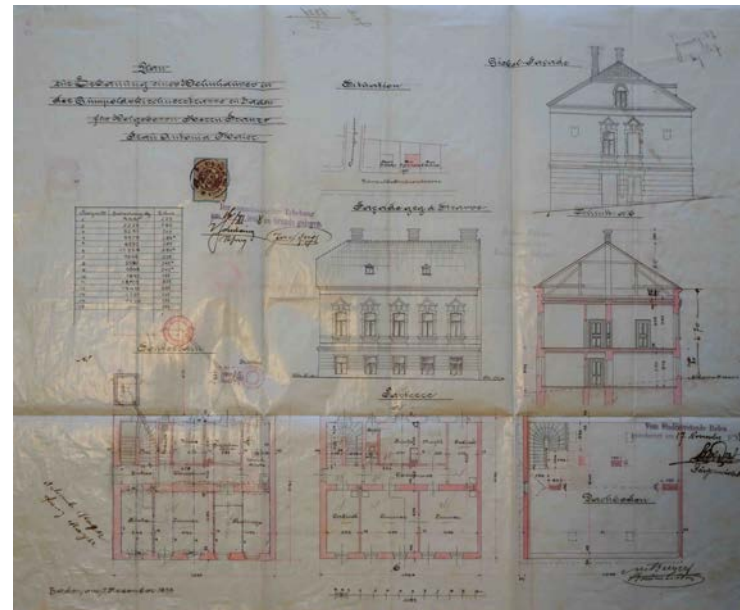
Einreichplan des Gebäudes Germergasse 42 vom 7.11.1898.
